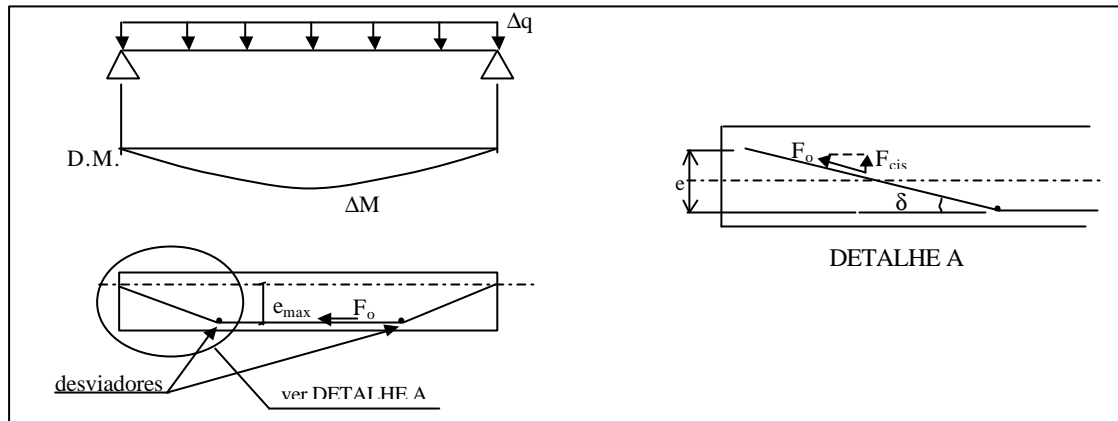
Reforços utilizando armadura longitudinal externa protendida
